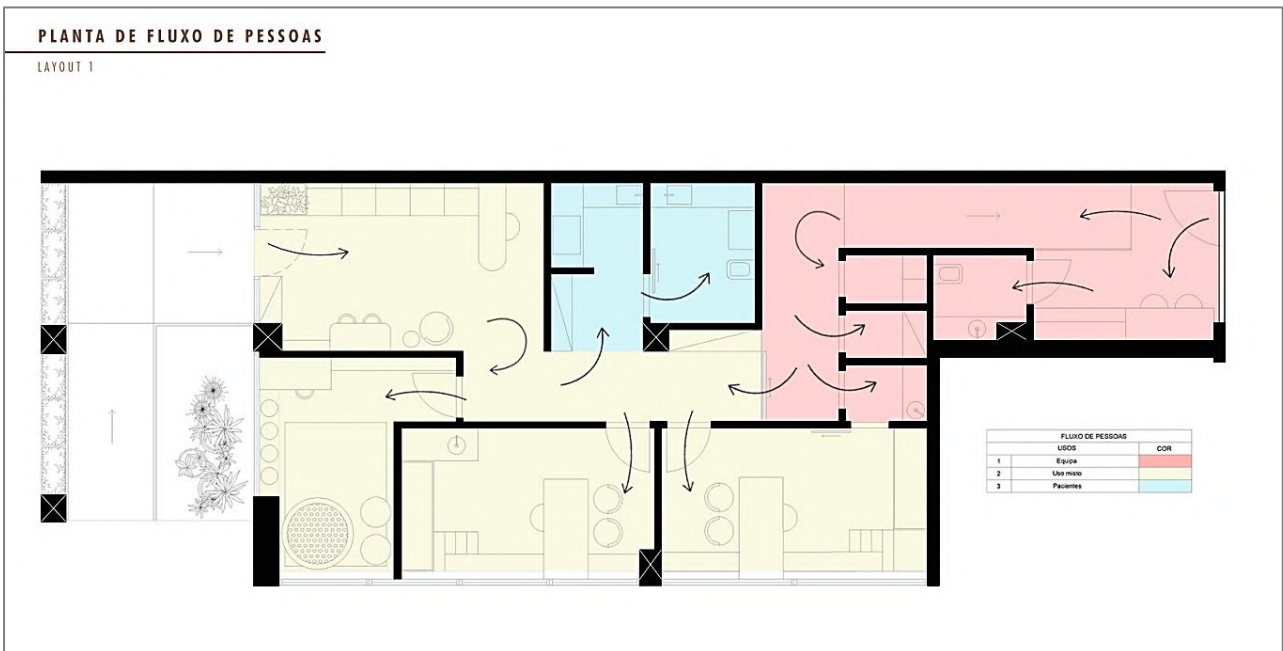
Planta baixa de fluxo de pessoas do primeiro layout do projeto CNP. Fonte: Equipa FBN.
